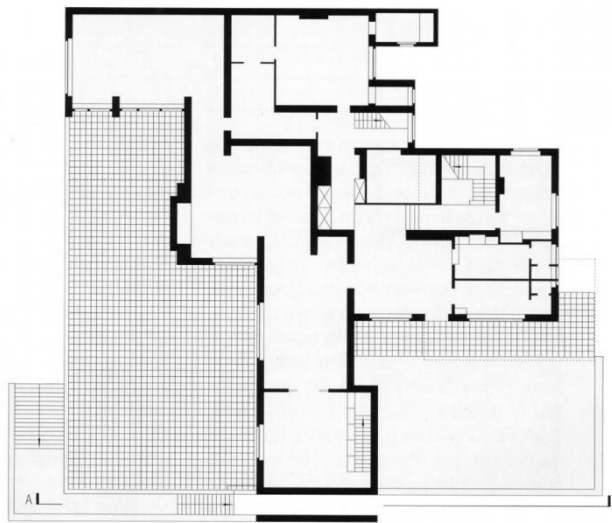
Planta do primeiro piso da *Casa Wolf*.
